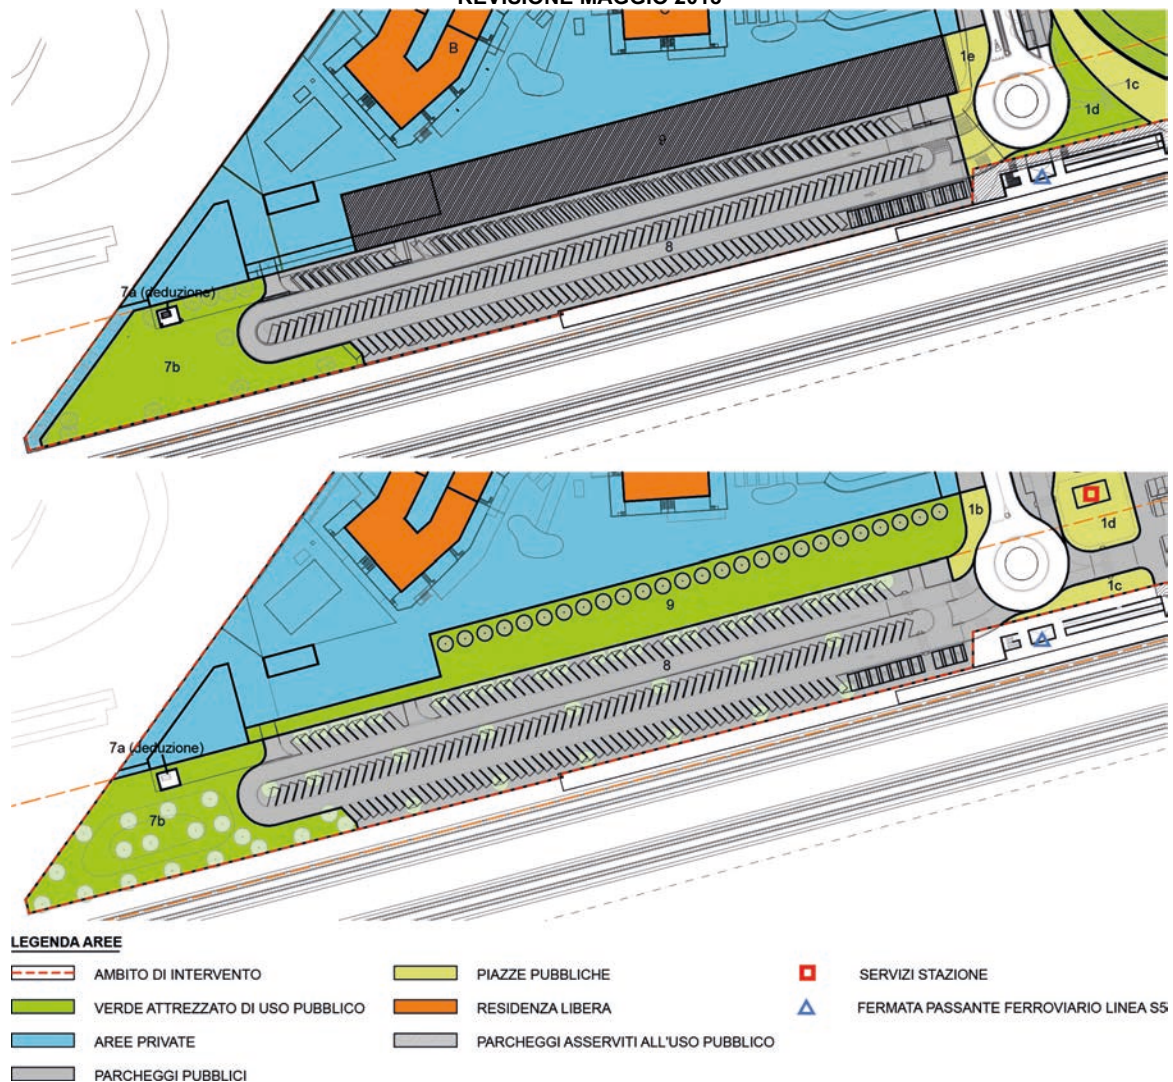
| La destinazione dell'area in oggetto secondo la planimetria di PII (sopra) e nella variante ultima revisione maggio 2018.
